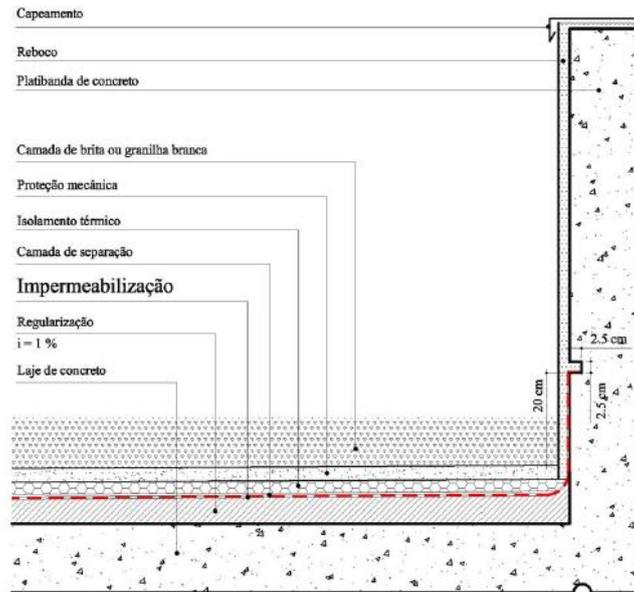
Detalhe de ancoragem da impermeabilização com rebaixo. Fonte: CRUZ (2003)
